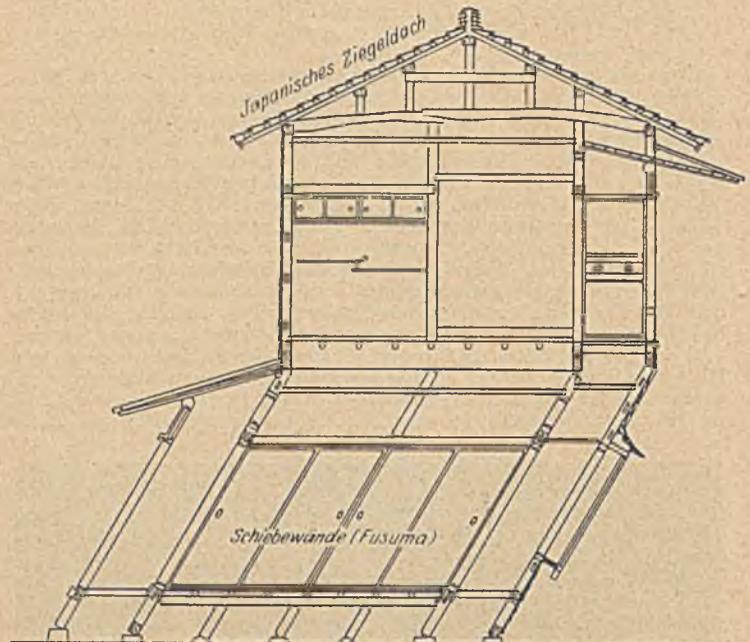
Typische Art der Zerstörung eines zweistöckigen Holzbaues.
